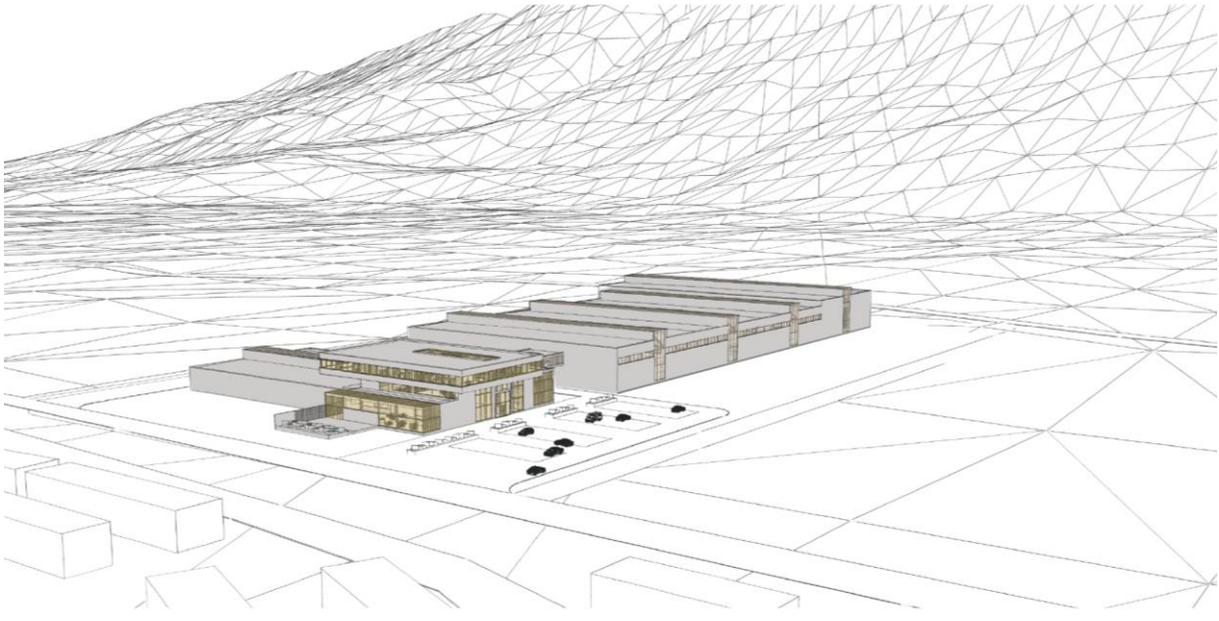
3D Axonometrie mit Umgebung und Lageplan Projekt Alpen Backwerk
